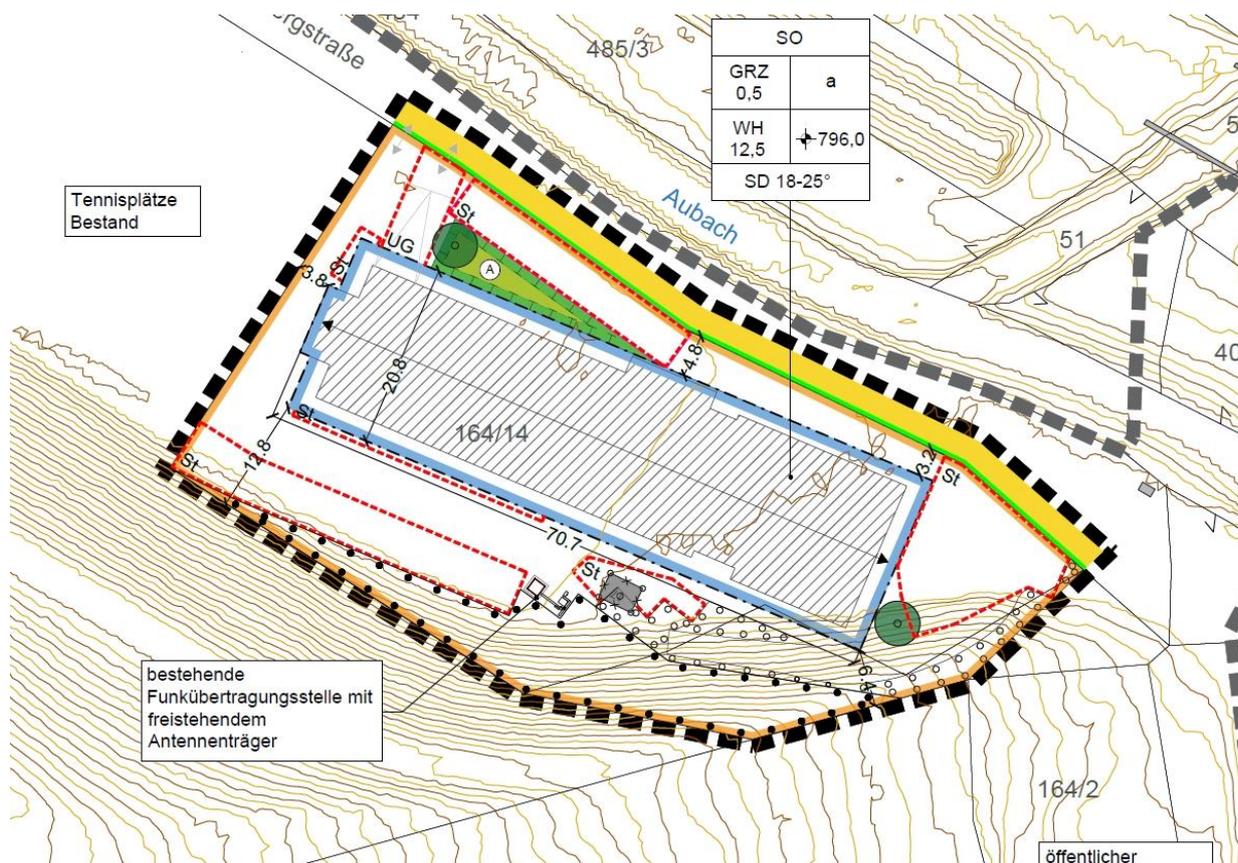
Bebauungsplan „Nr. 5 „Am Seeberg“ 3. Änderung als vBP/GOP“, Quelle: Planungsbüro Hohmann-Steinert,
